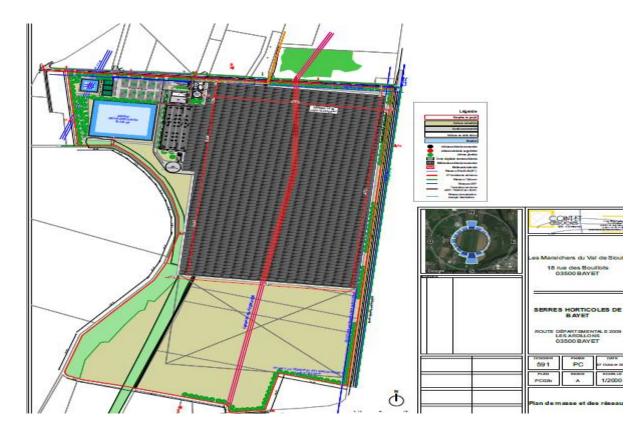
Plan de masse du projet (source : dossier Permis de construire)
